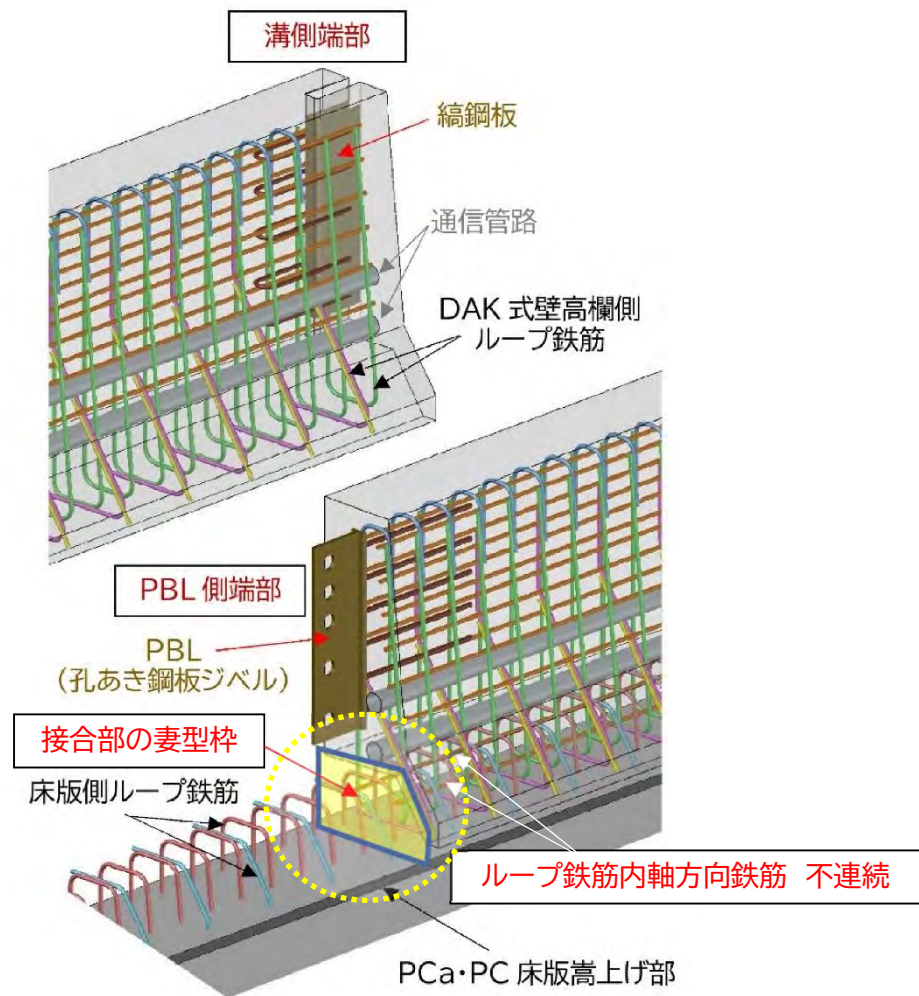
接合部のループ鉄筋継手内に配置される橋軸方向鉄筋の不連続配置図
